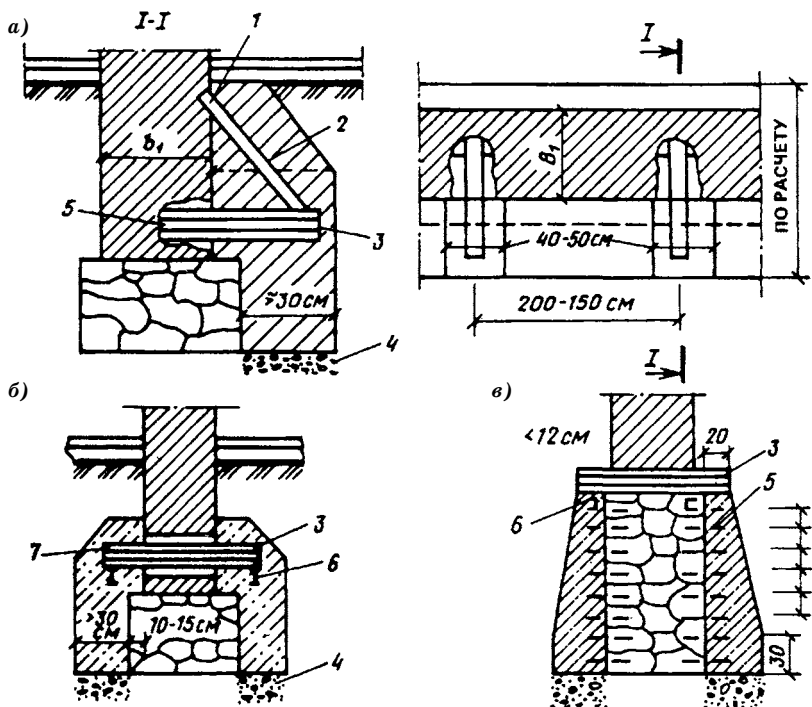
Уширение фундаментов монолитными банкетами:
